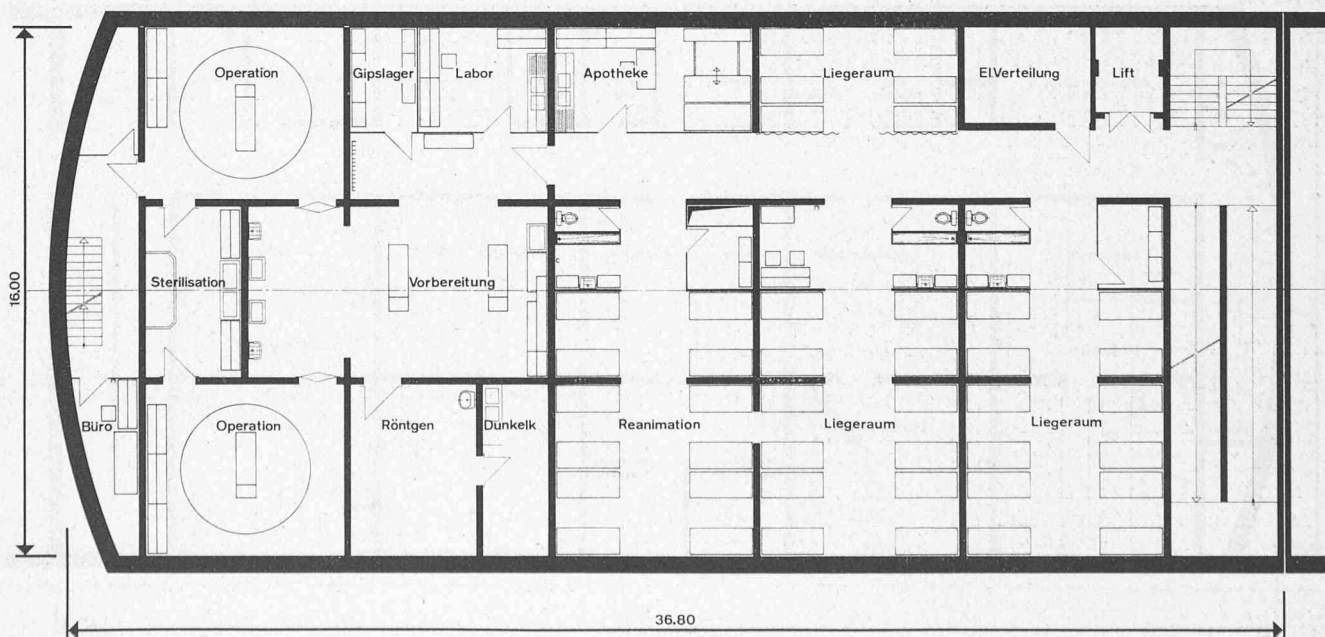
Grundriss des ersten Obergeschosses (1.OG) der ZSO-Kaverne mit Notspitalbehandlungstrakt
